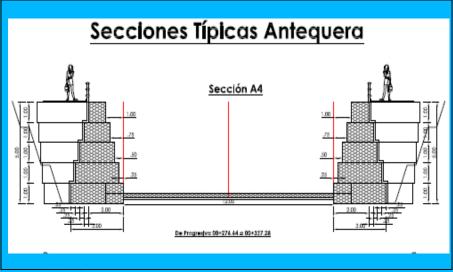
Sección típica del Canal conformado por los muros laterales y el fondo del canal revestido con la plataforma antisocavante colchón Reno.
